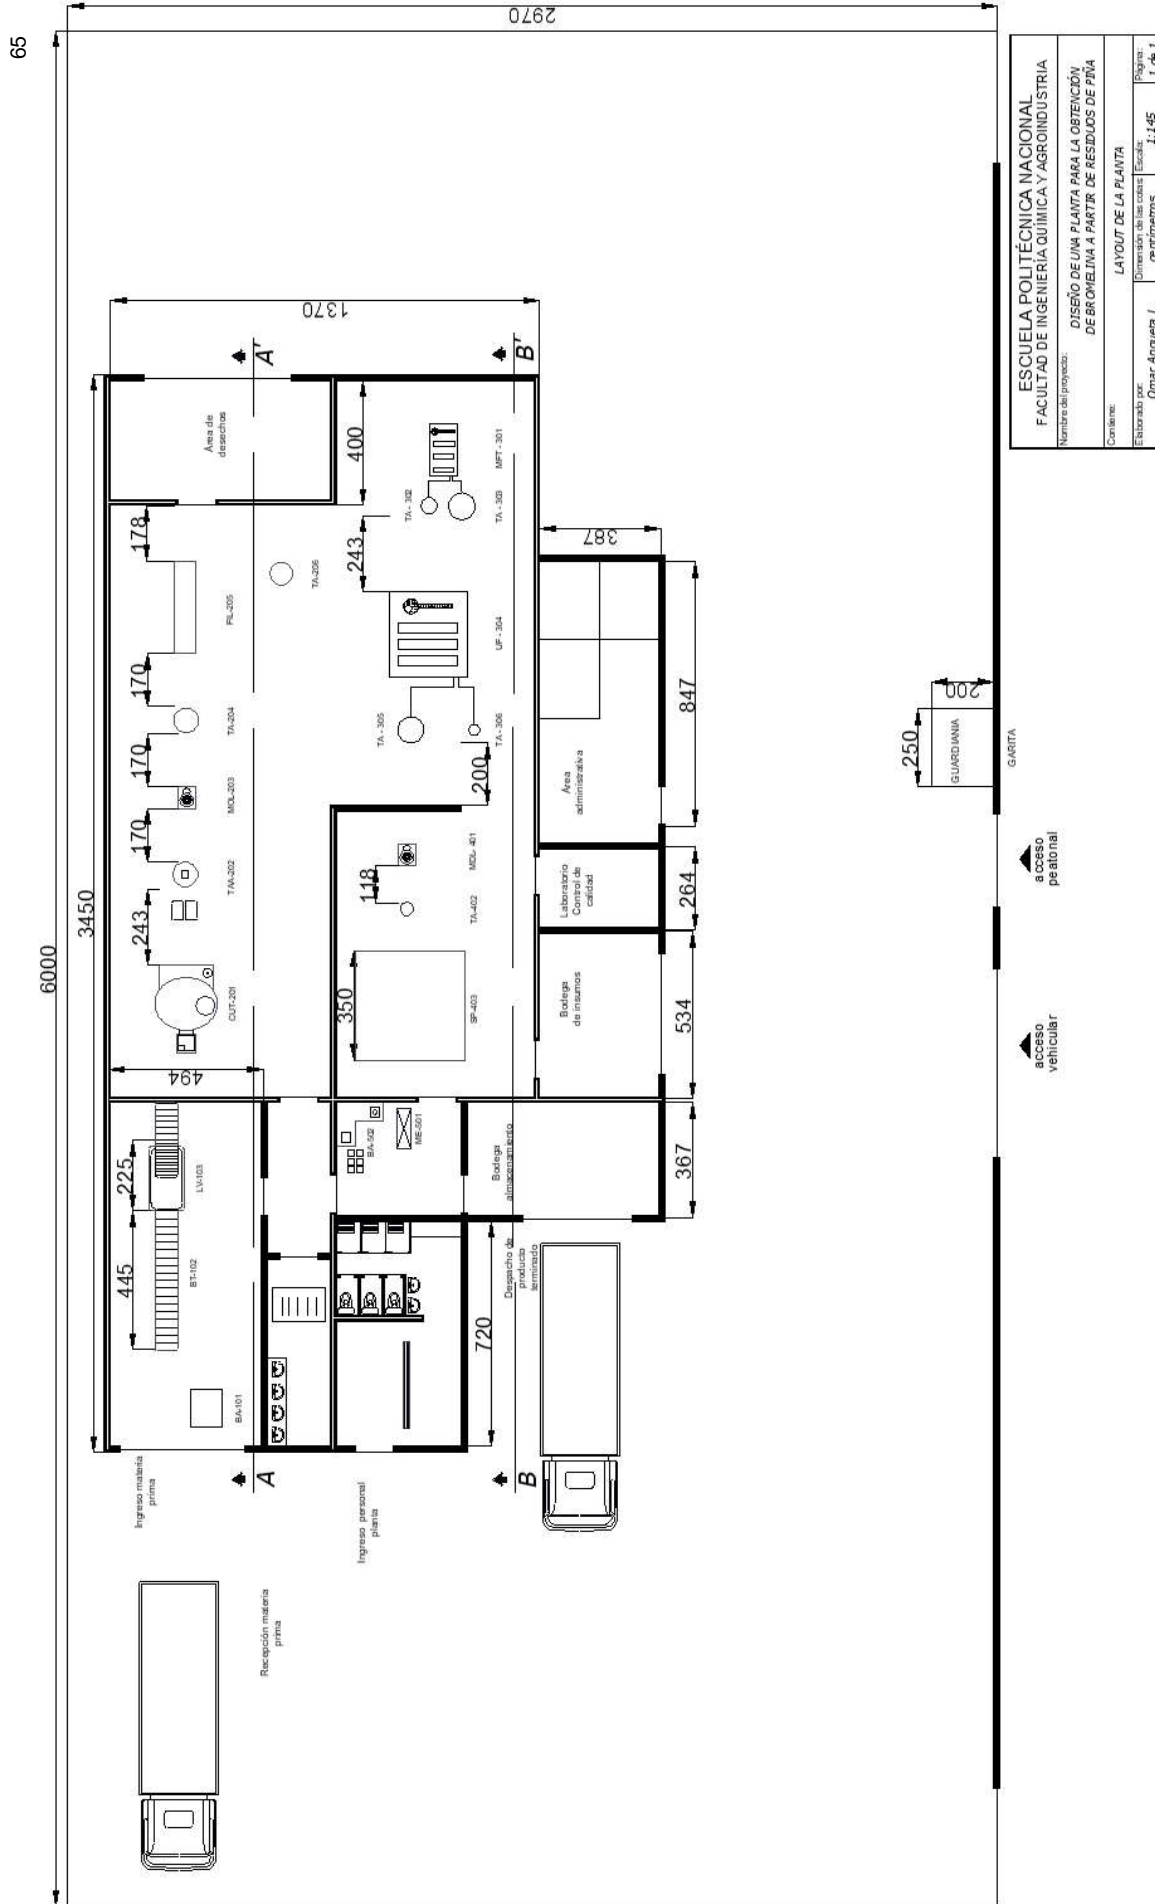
Layout de la planta de extracción de bromelina a partir de residuos de piña con cortes
